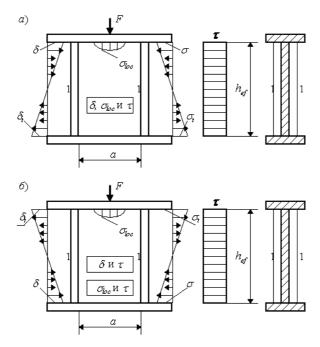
Схема балки, укрепленной поперечными основнымиребрами жесткости (1)
